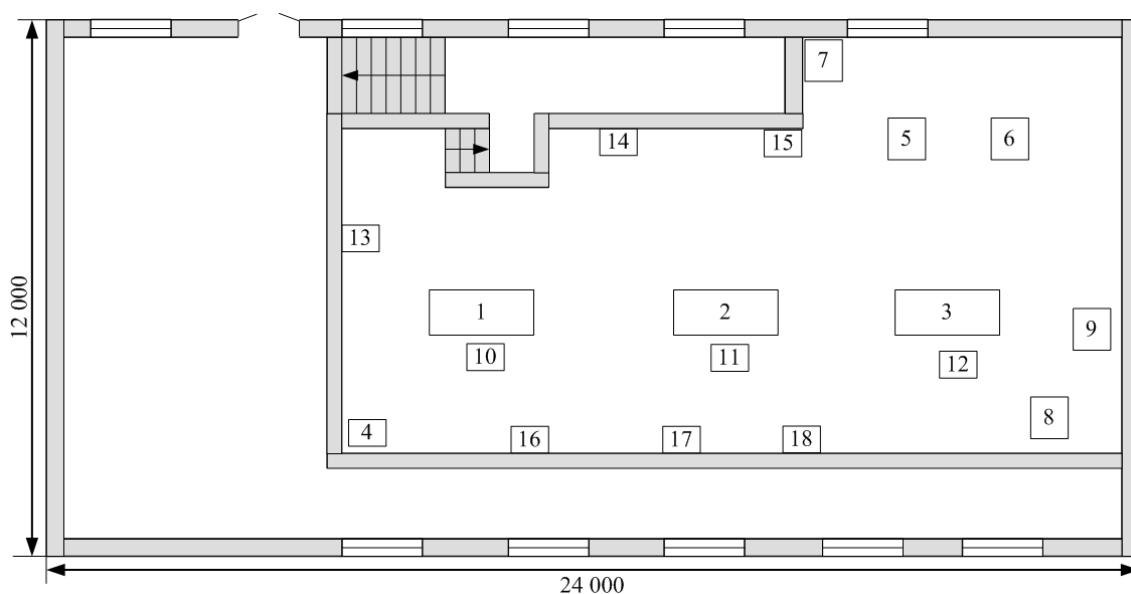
План насосної пожежогасіння (№8 на генплані)
